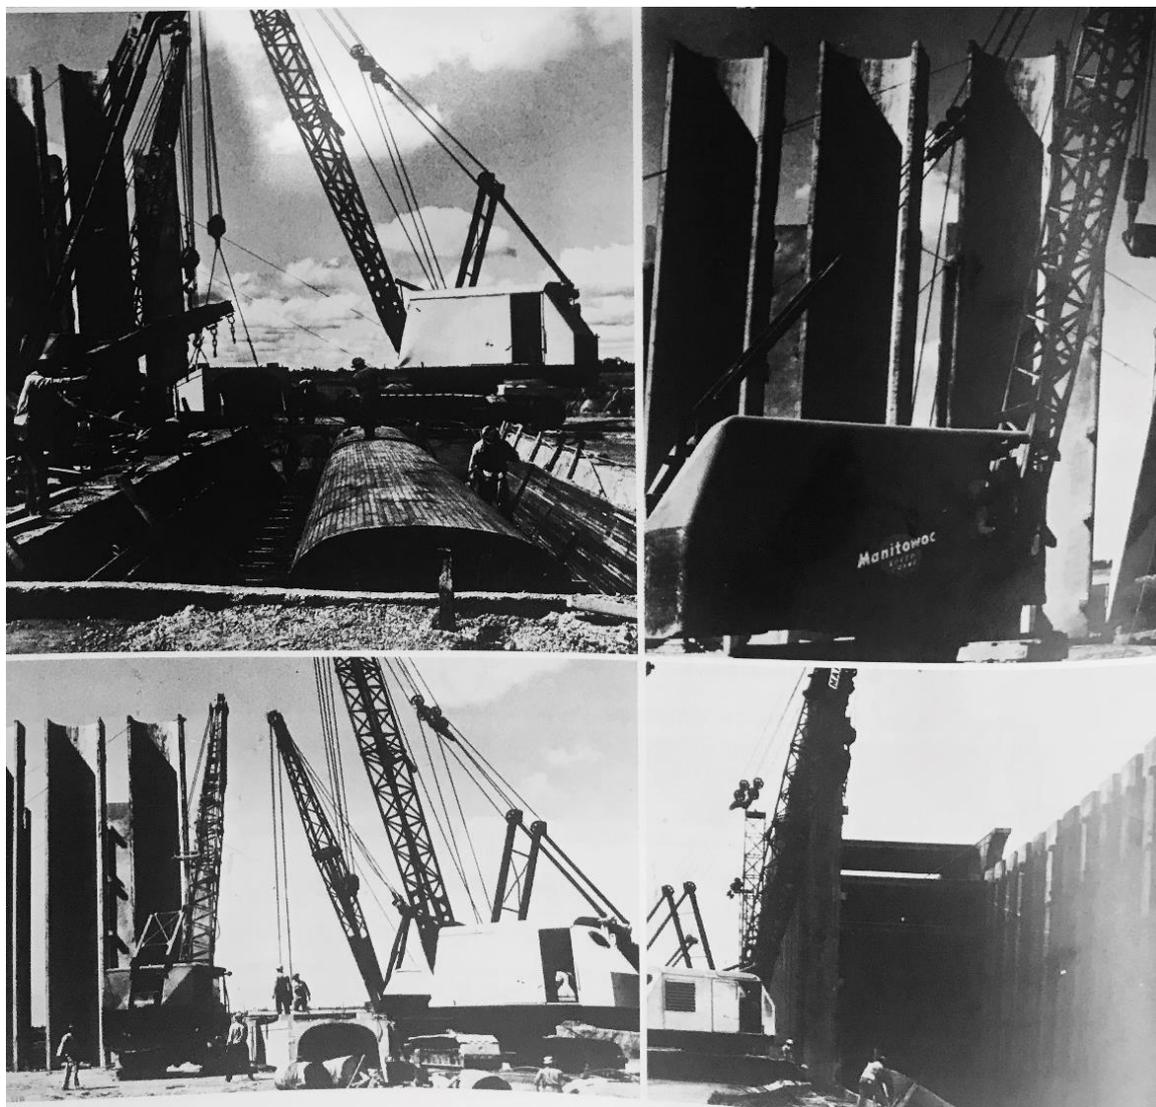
Montagem do Sistema Construtivo do Bloco A. Fonte: Revista L'Architecture D'Aujourd'hui n. 171.
